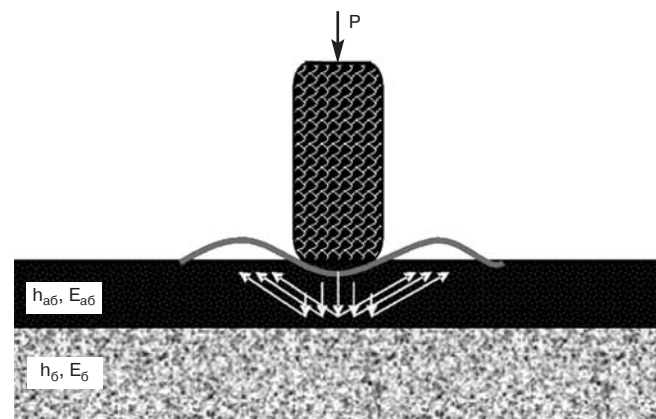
Схема работы асфальтобетонного покрытия на цементно-бетонном основании
